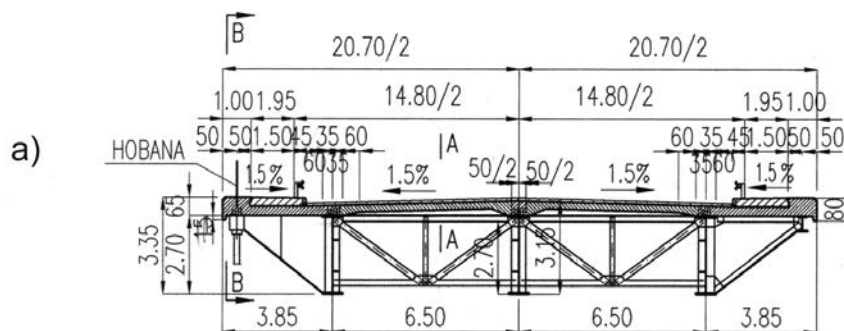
Pod hobanat. Platelaj metalic cu placă din beton armat
